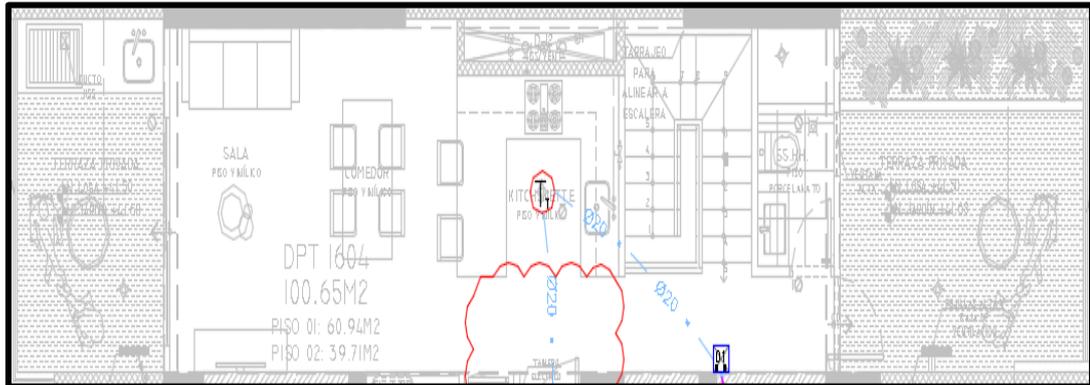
Equipos en departamento con 02 dormitorios 02 pisos (2° Planta)
